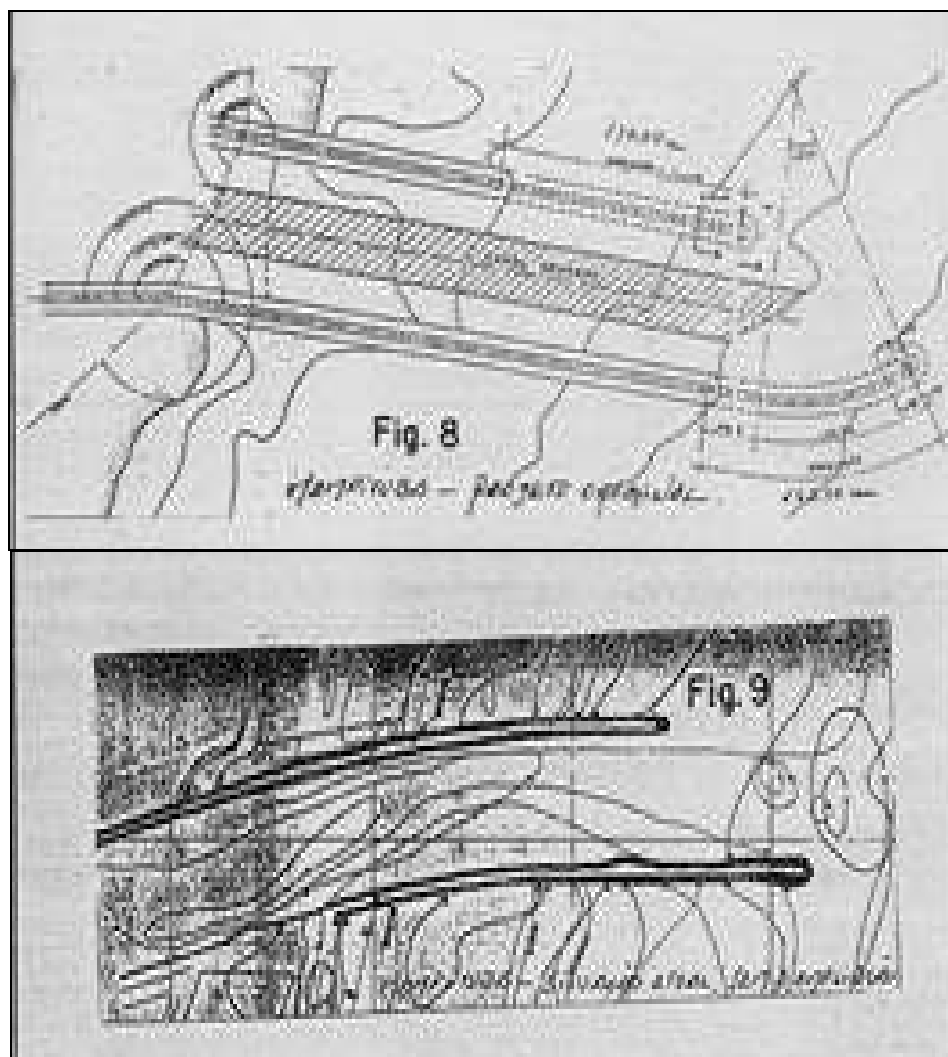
Plantas originais para a obra de construção dos molhes do rio Mampituba. Destacando no croqui 1, que as partes pontilhadas não foram construídas, e no croqui 2, os bancos de areia na boca da barra. Fonte: INPH (1999).
